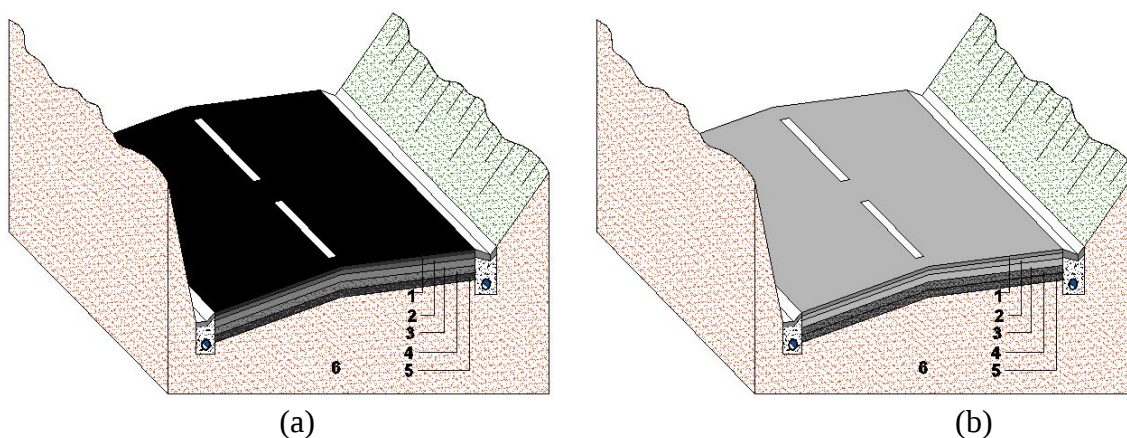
Constituição de um pavimento rodoviário: (a) Flexível; (b) Rígido
